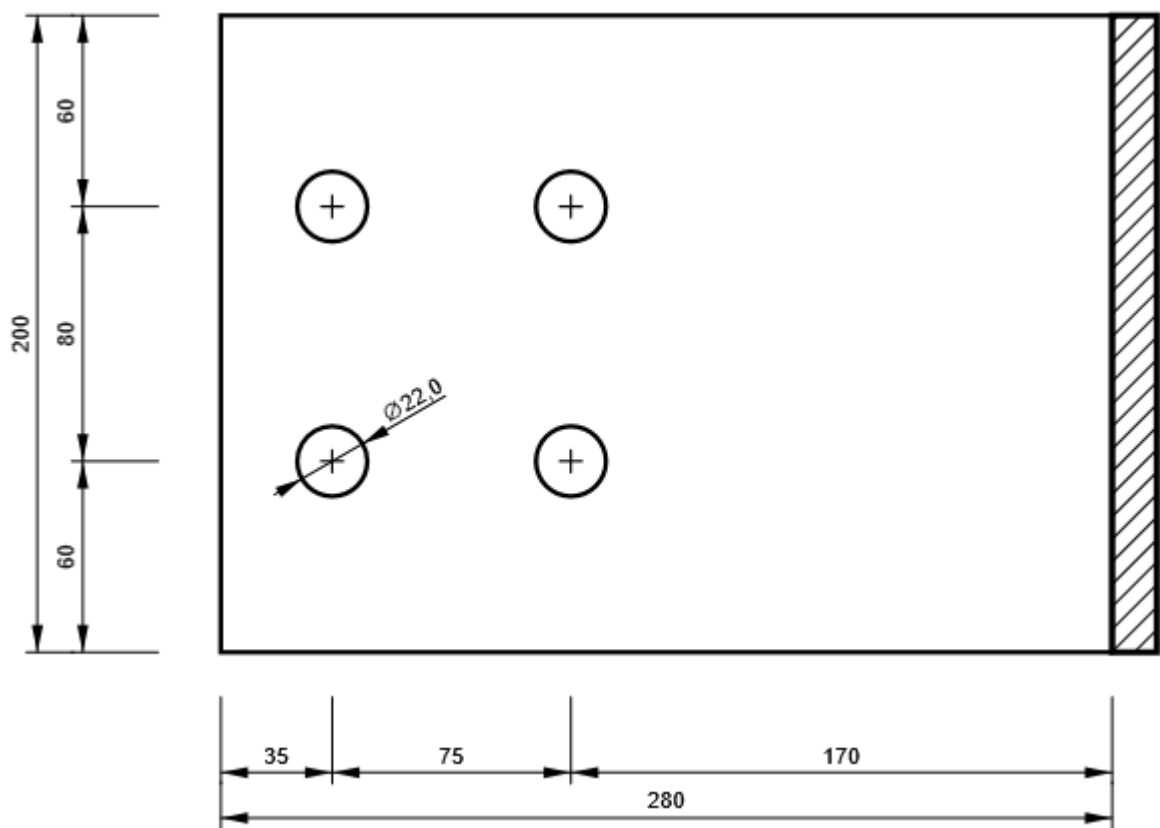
Dimensions et disposition des boulons et cordons de soudures sur la plaque de connexion.
